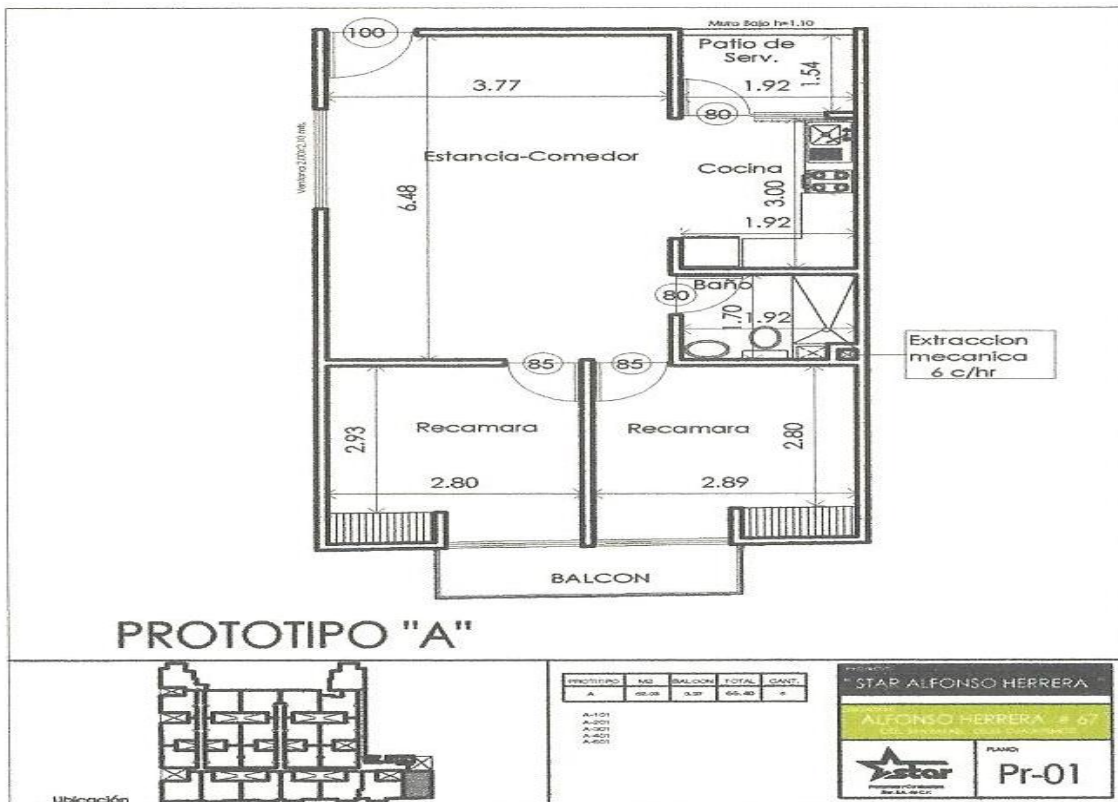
Diseño arquitectónico de un departamento prototipo.
